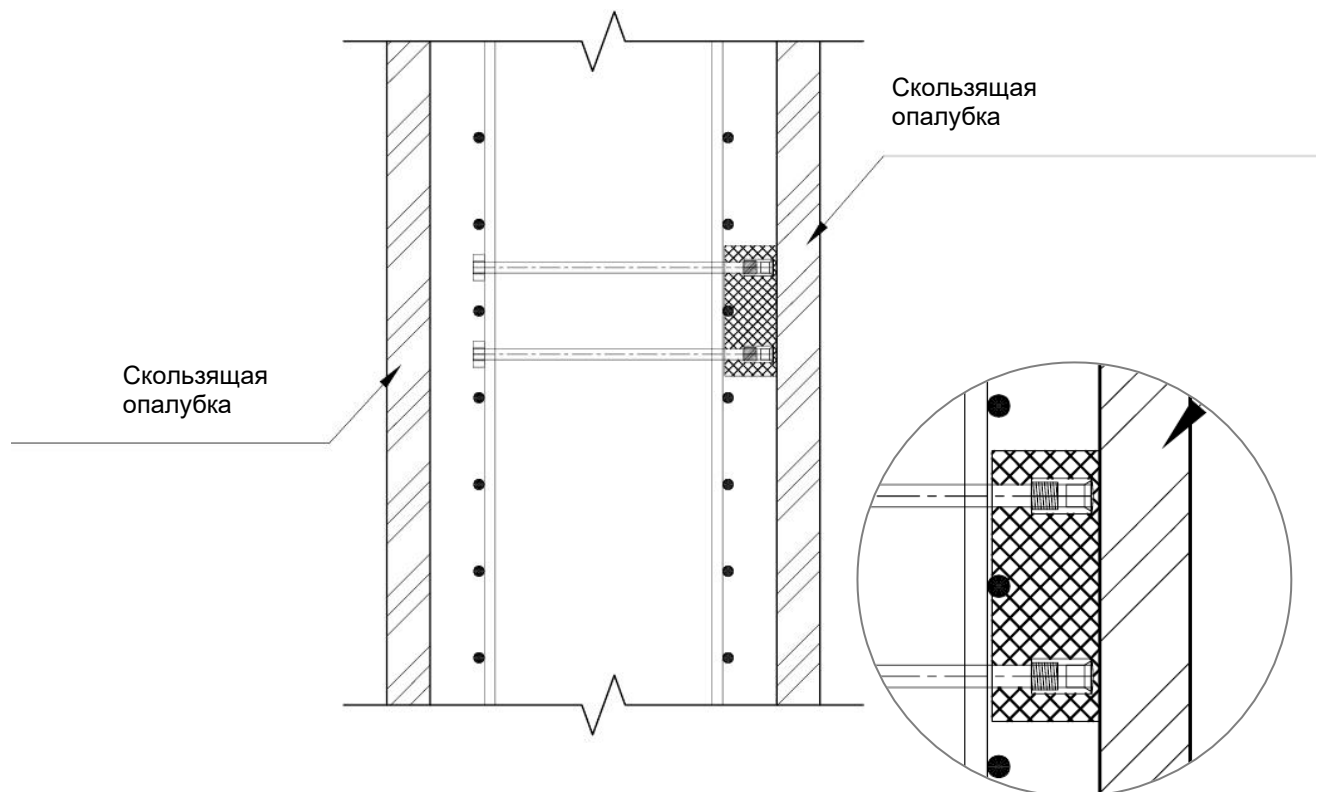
Установка и подъем скользящей опалубки
